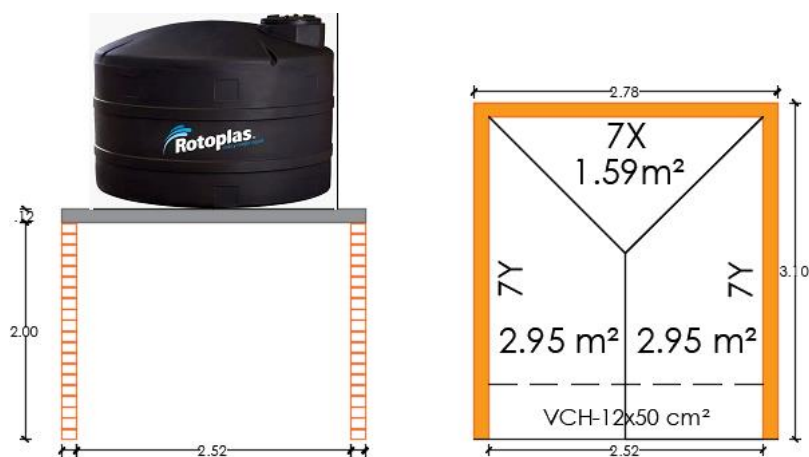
Losa de apoyo y tanque de polietileno (Fuente: Elaboración propia)
